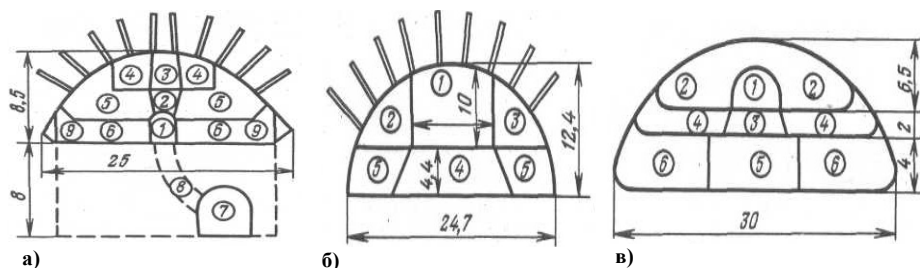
Схемы разработки сводовой части подземных ГЭС:
